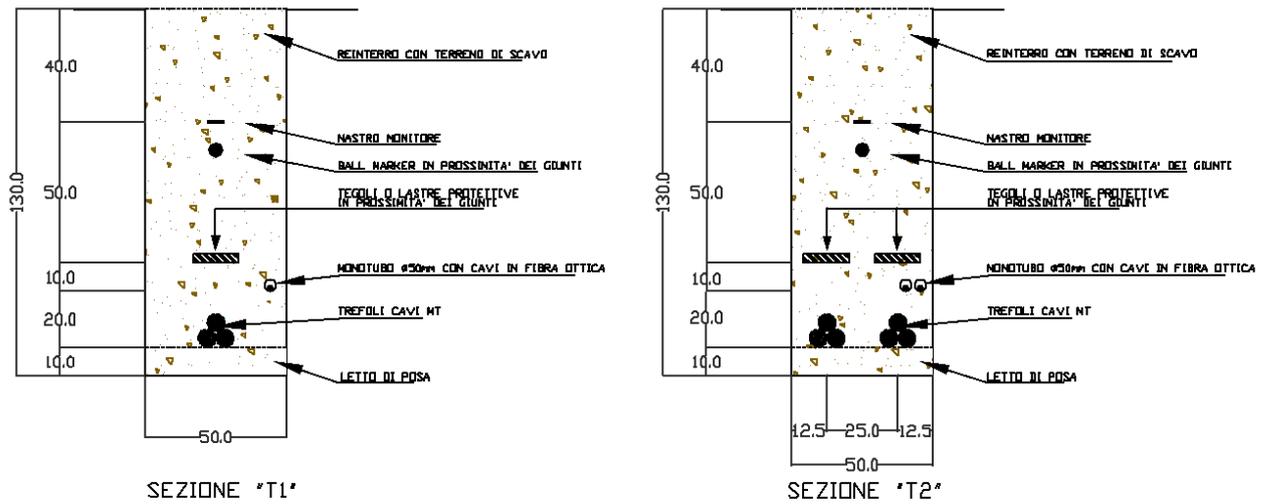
sezione tipo cavidotto su terreno in fregio alla viabilità
